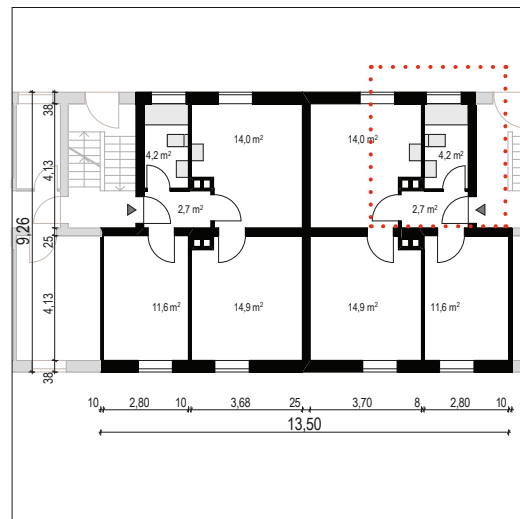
Beispielgrundriss Ingolstadt, Schubertstraße 34–36
